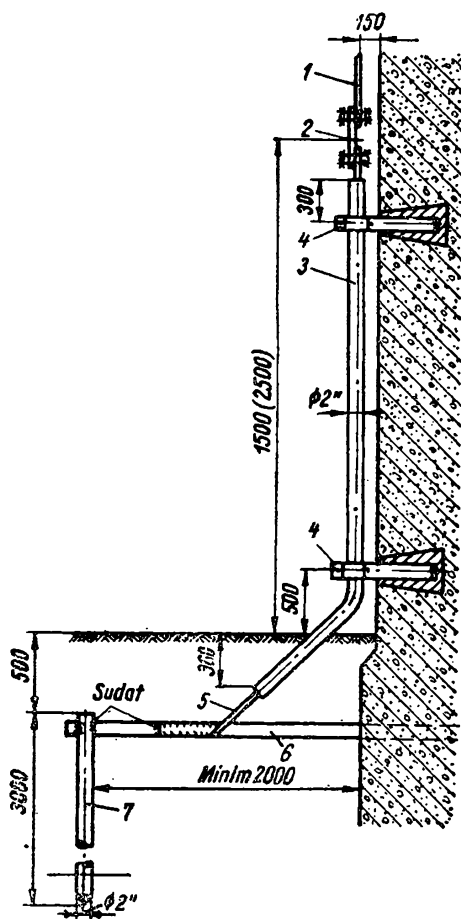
Dispozitiv de legare la pămînt (detaliu) cu elementele componente din oțel zincat:
